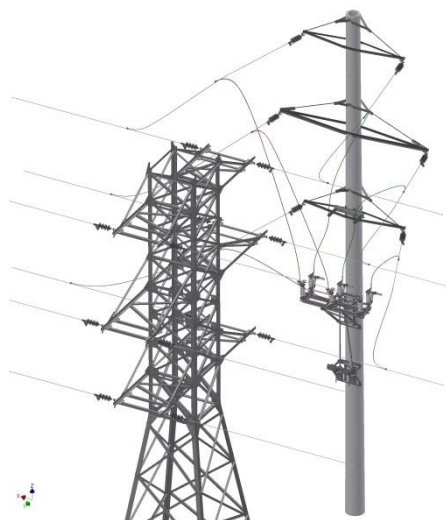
Установка разъединителя на дополнительной опоре со стойкой СК22
